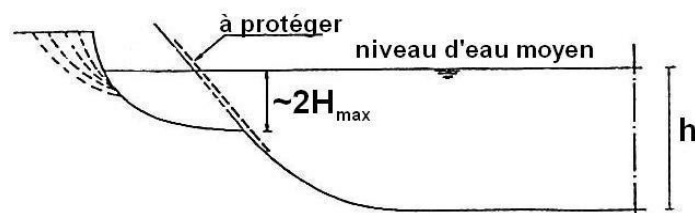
Profil en travers d'une berge de voie navigable [AIPCN, 1997]
